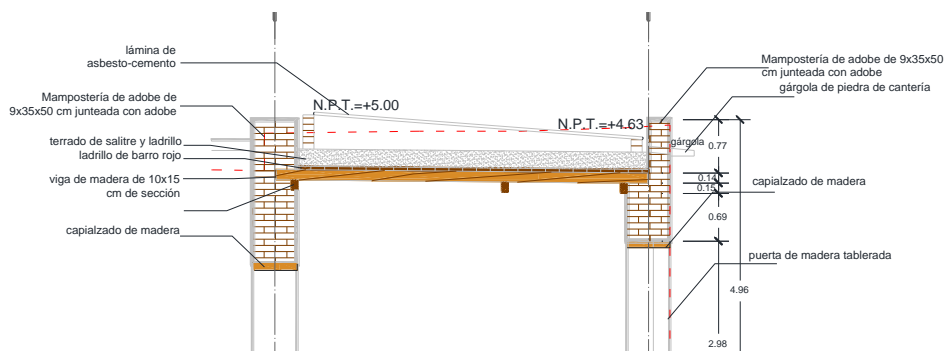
Vista de uno de los sistemas constructivos de cubierta utilizados en la vivienda.
